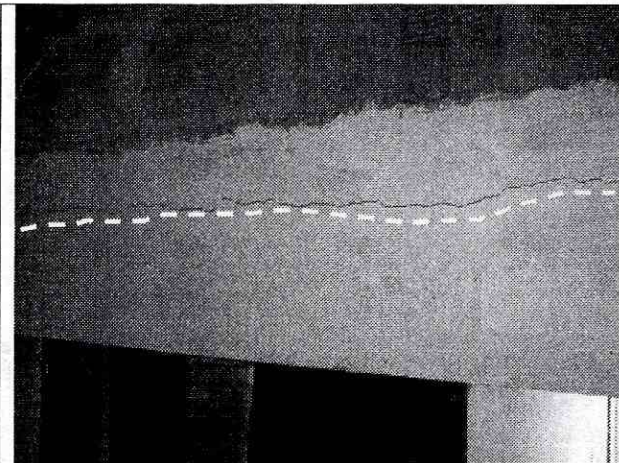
Vista de la viga en el predio evaluado, que se ubica hacia el sector del corredor la cual presenta fisuras de aproximadamente 5 mm de abertura y se encuentra apoyada en puntales de madera.
